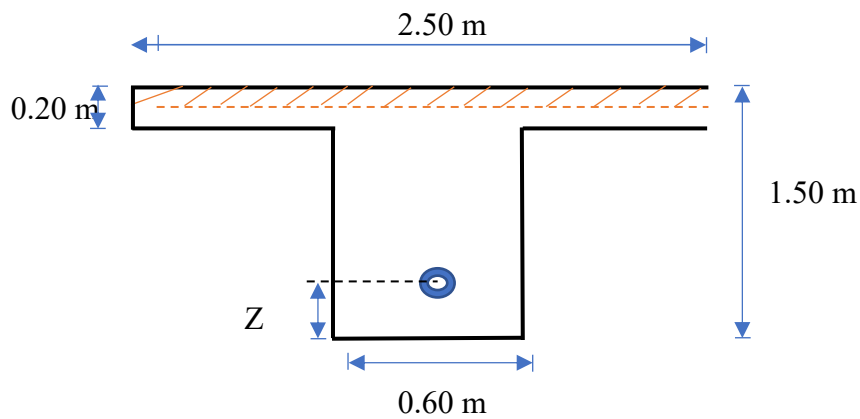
Sección transversal de viga exterior para cálculo de c
